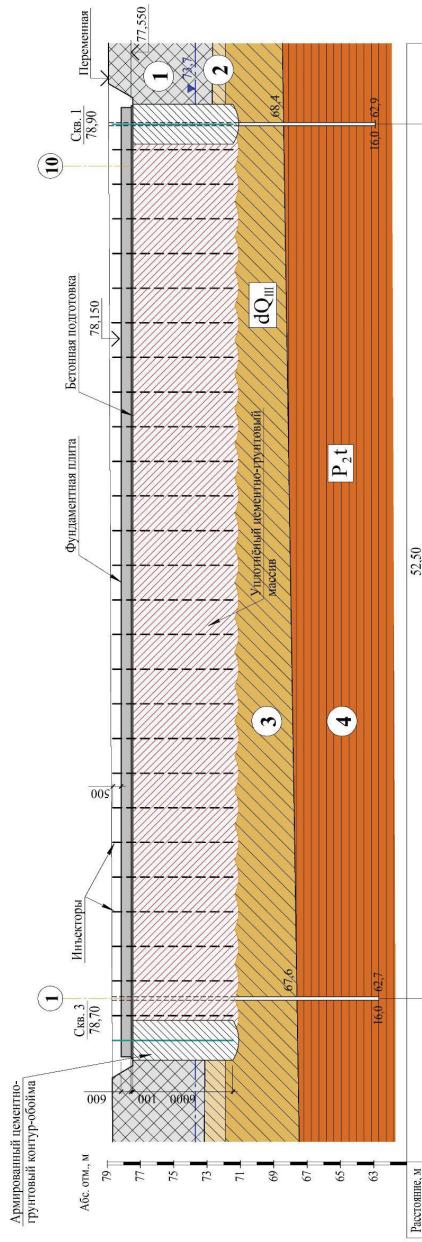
Монолитная железобетонная фундаментная плита на цементно-грунтовом основании. Разрез I-I
